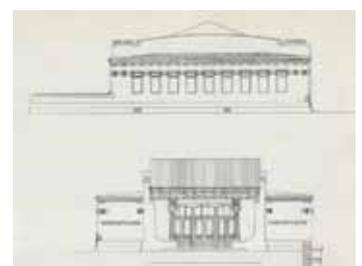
Planos de la fachada frontal y la fachada lateral de la estación Roselauerlände
